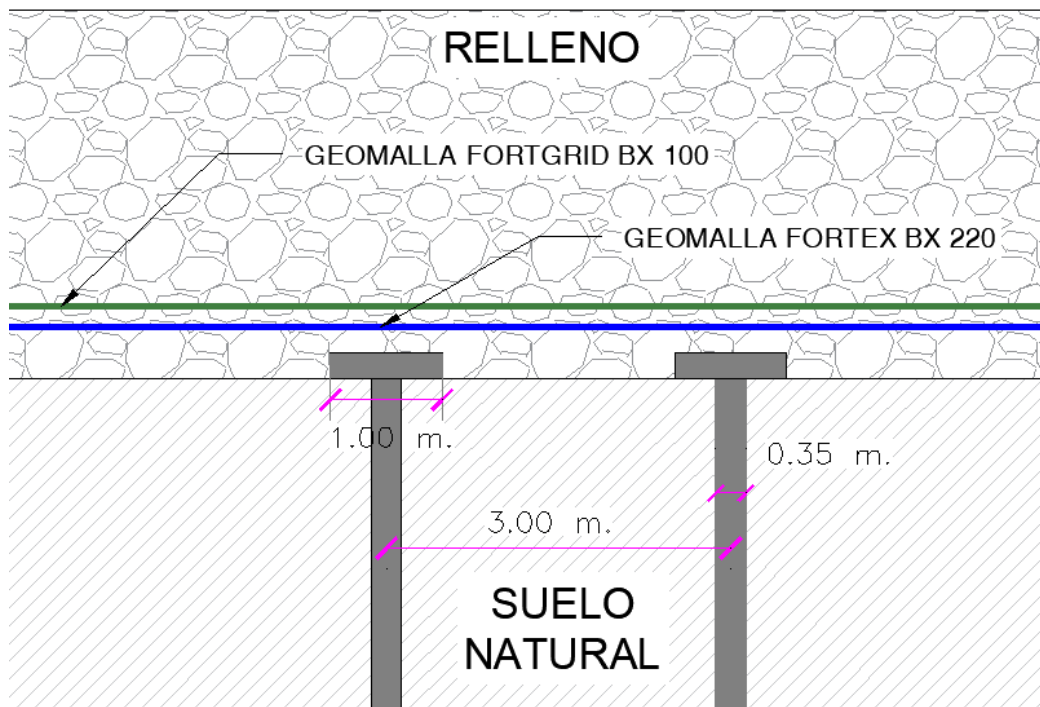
Detalle de alternativa de pilotes bajo terraplenes.
